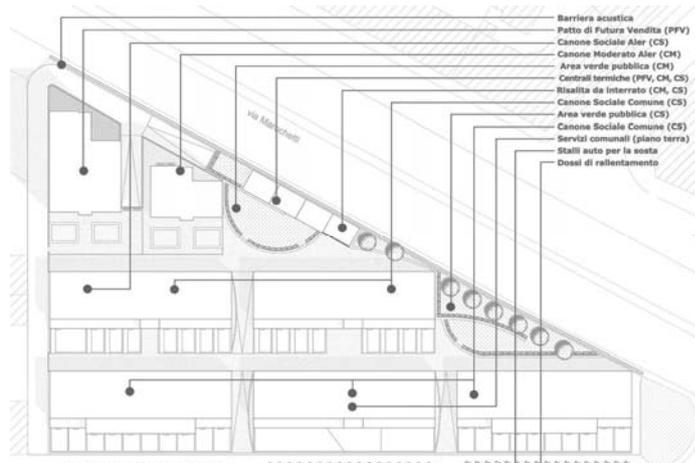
Planimetria del progetto proposto dal gruppo di ricerca con indicazione delle funzioni
